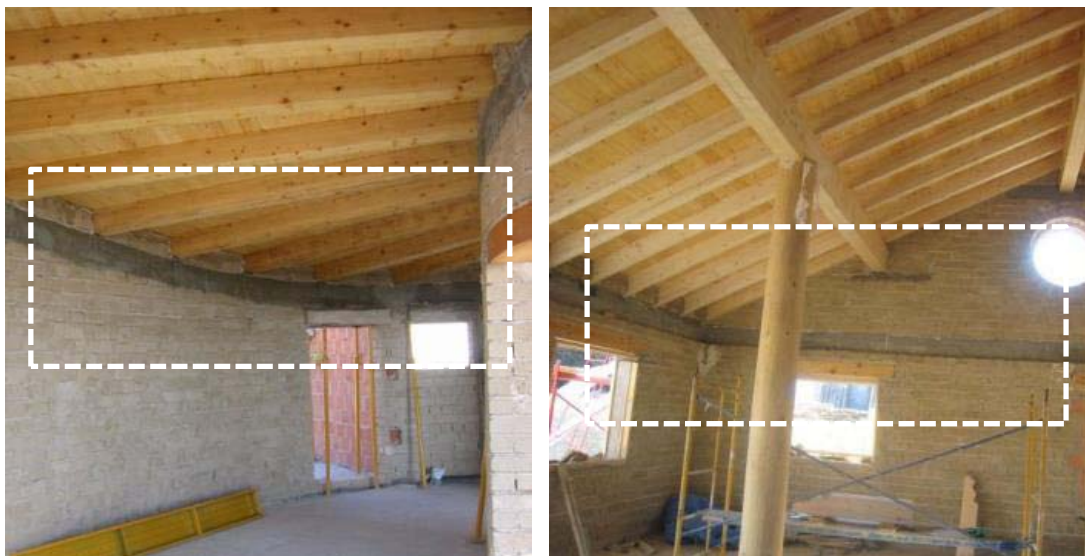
Coronación ZAR-002 y HUE-001. Apoyo en viga perimetral de hormigón armado de la cubierta. Fuente: Petra Jebens- Zirkel.
